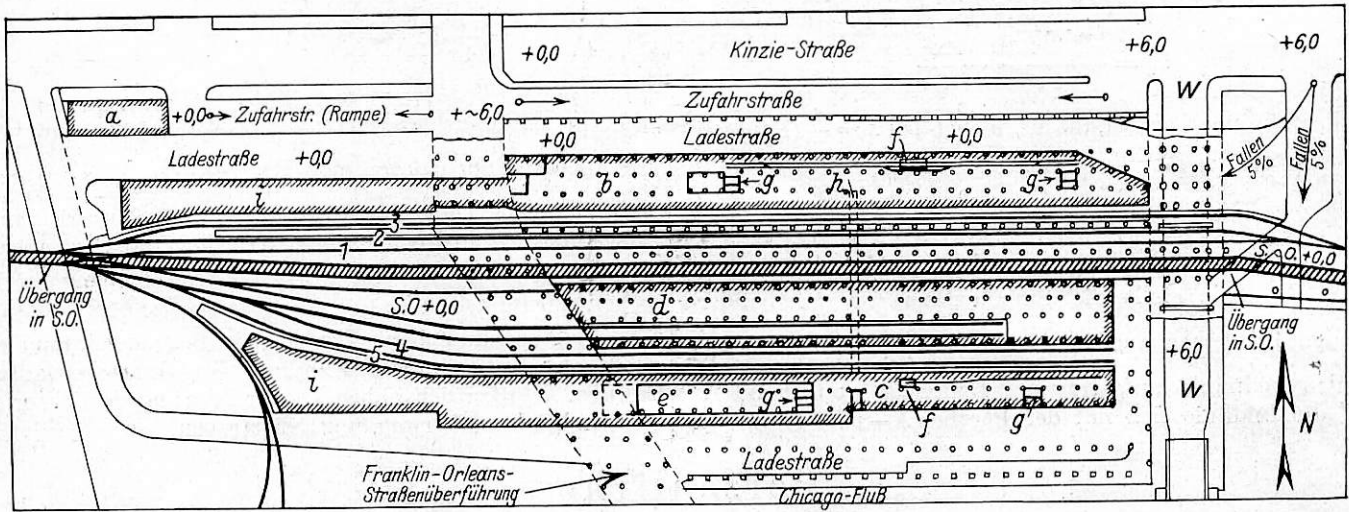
Grundriß des Stückgutbahnhofes in Chicago.
